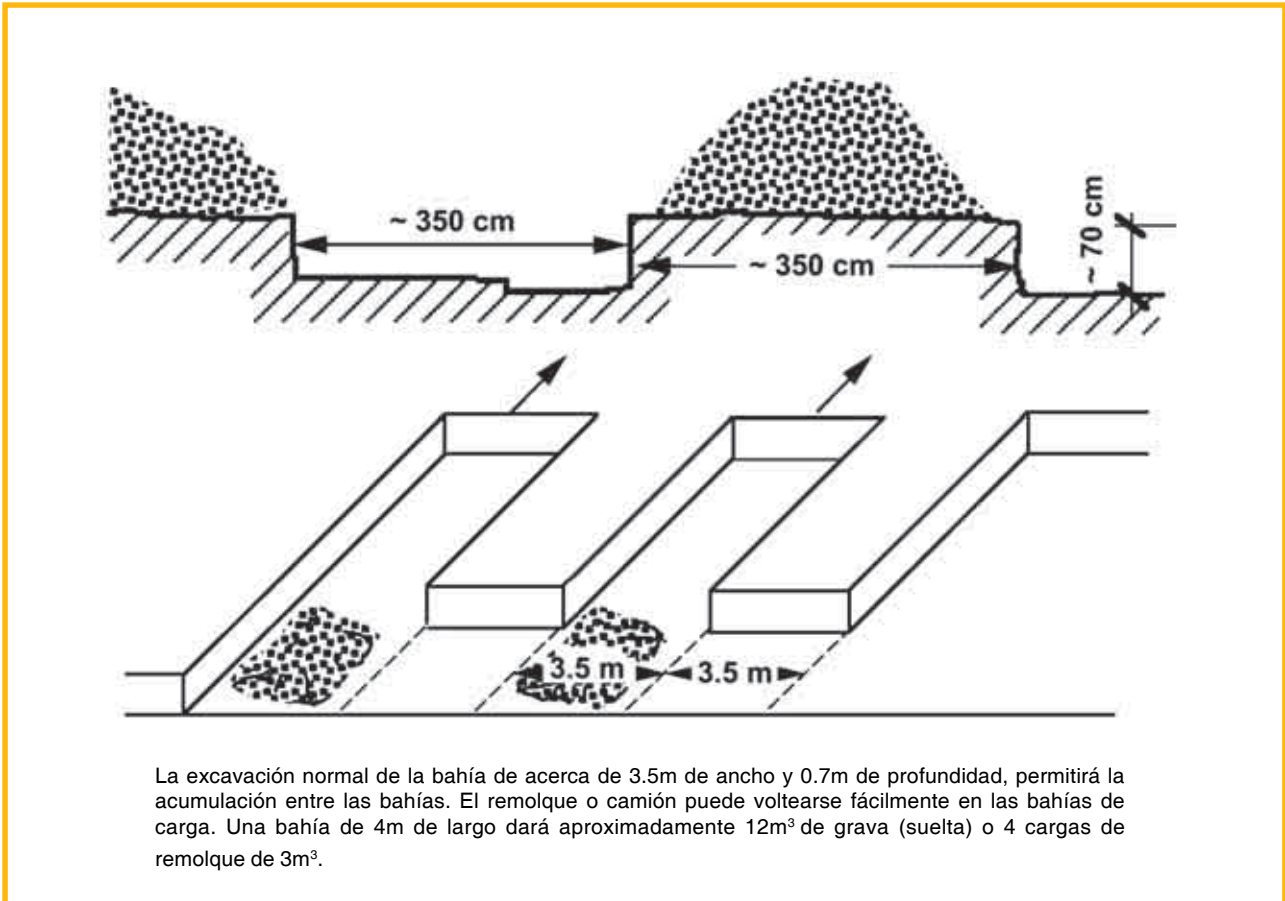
Desarrollo de la cantera sobre suelo plano
